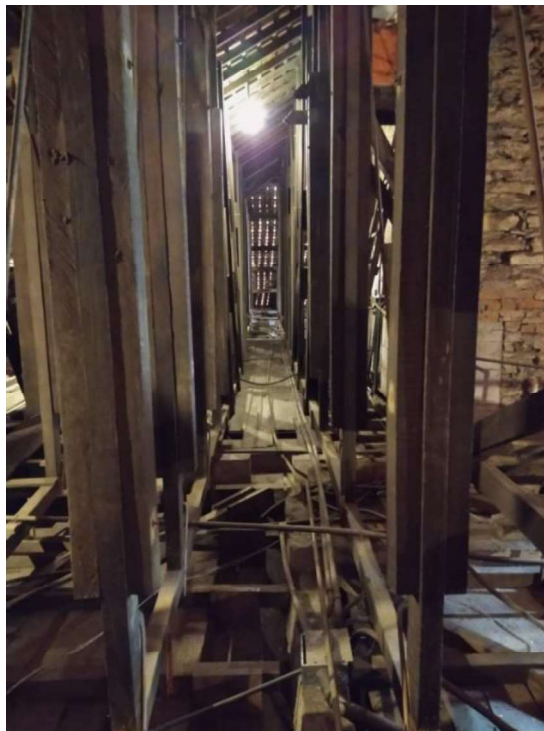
Corredor entre as seções treliçadas, evidenciando a amplitude do telhado.
